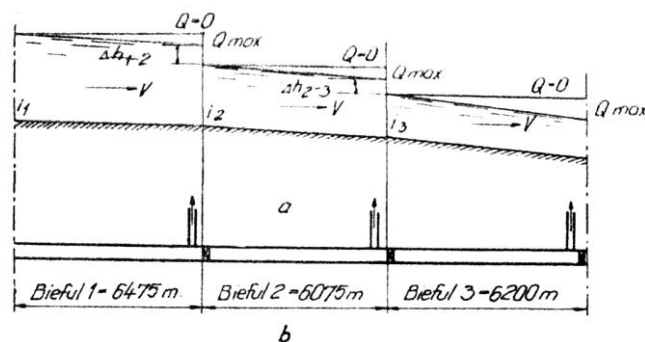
Schema biefurilor luate în calcul: a – secțiune longitudinală; b – vedere în plan.
